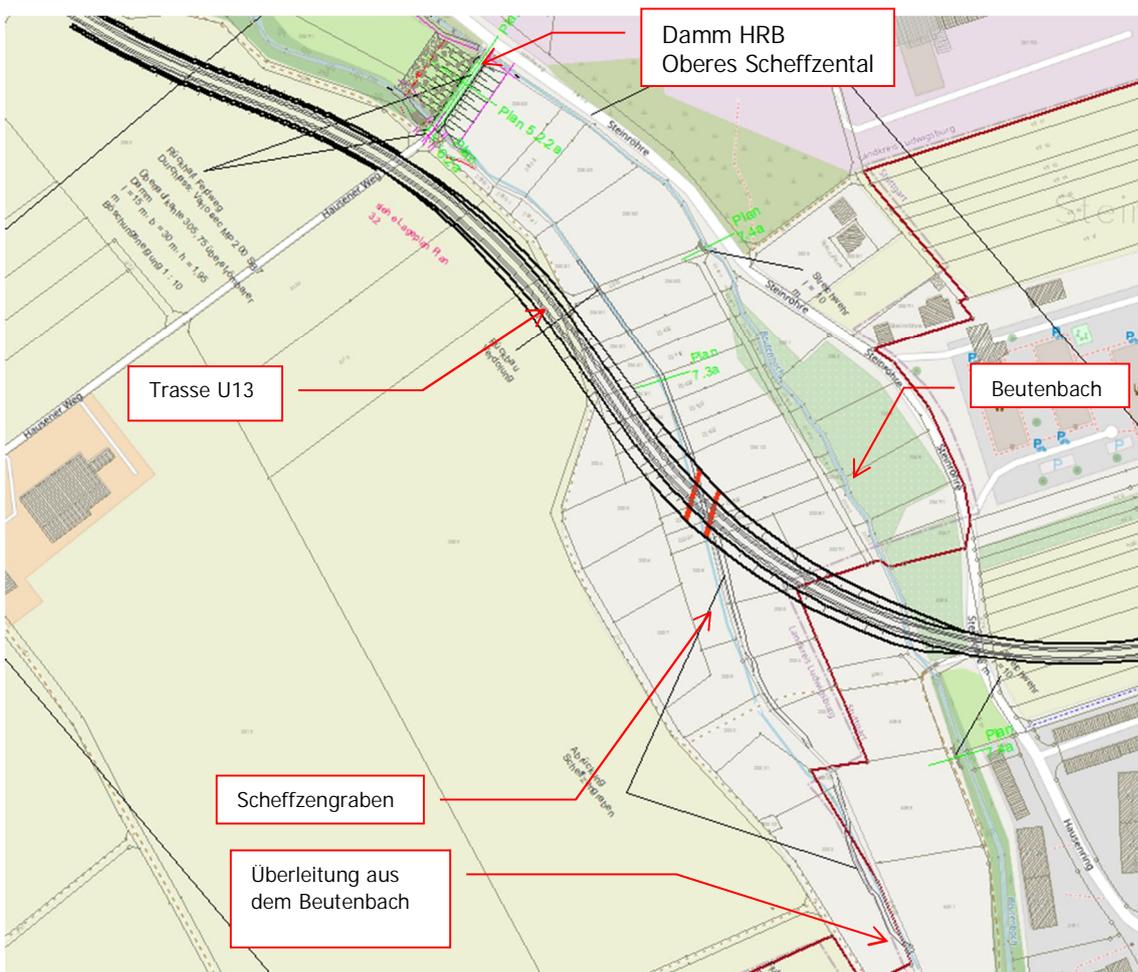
Lage des geplanten Straßenbahndammes Trasse 3 (SSB, Stand 29.01.2021)
